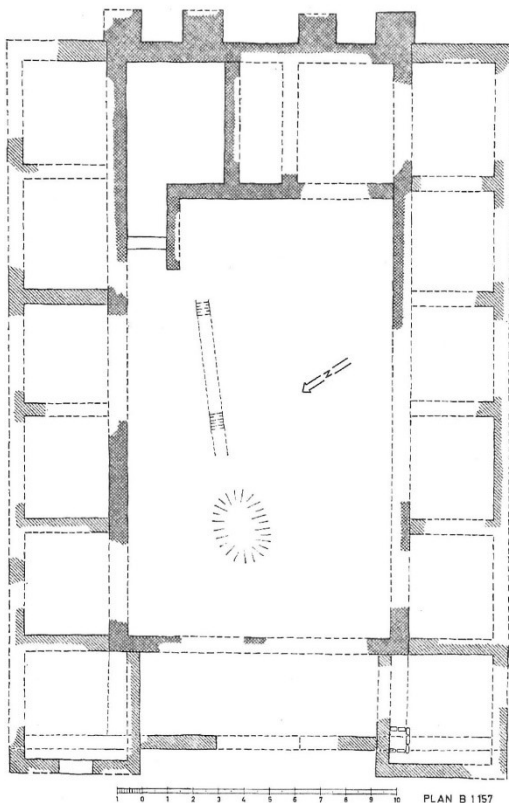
Planimetria dell'edificio 2 (stazione di sosta?). Fonte: Binsfeld 1969, p. 251 Abb. 8.
